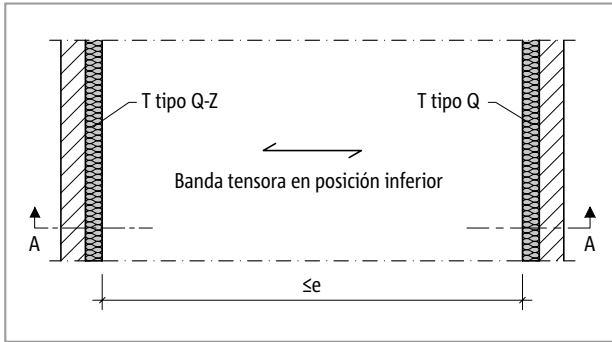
Schöck Isokorb® T tipo Q-Z, Q: Losa de hormigón armado tensada sobre un eje
